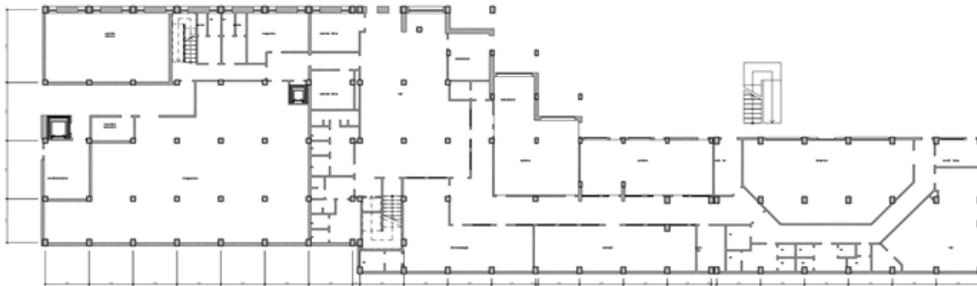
pianta del piano interrato dell'Hotel San Faustino
